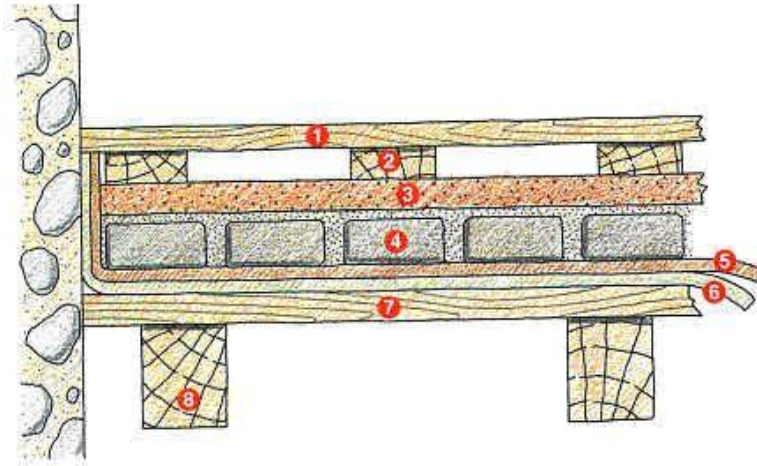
Esempi di costruzione di solaio d'interpiano con struttura portante in legno. 1. pavimento in abete; 2. correntini in abete; 3. isolamento termoacustico; 4. mattoni di terra cruda; 5. isolamento anticalpestio; 6. guaina; 7. assito a vista; 8. travetti portanti. (Chinello, 2006).
